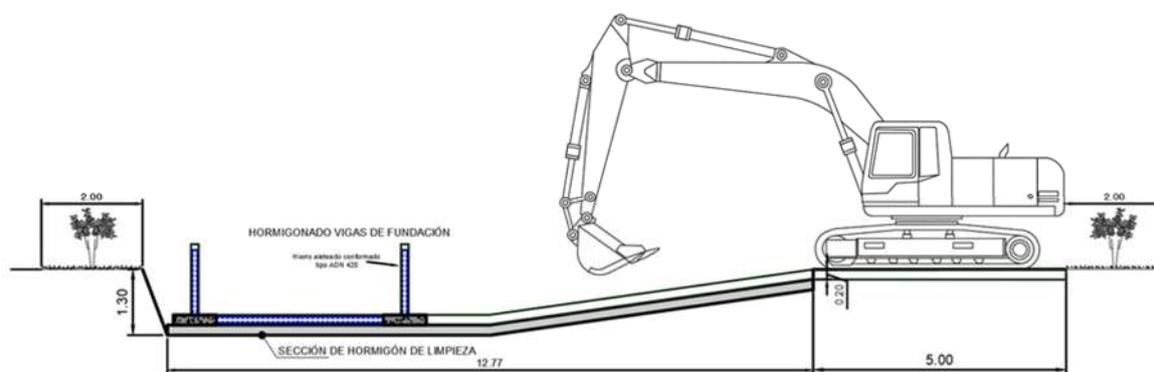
Sección de vigas de fundación. Hormigón tipo H30-CAH.
